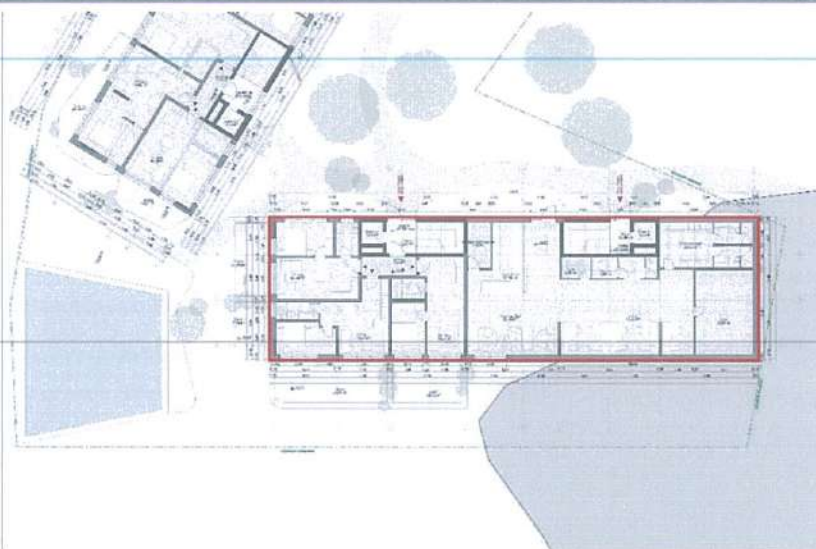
Planimetria e katit përdhe – Sip. kati përdhe 484.3m²
